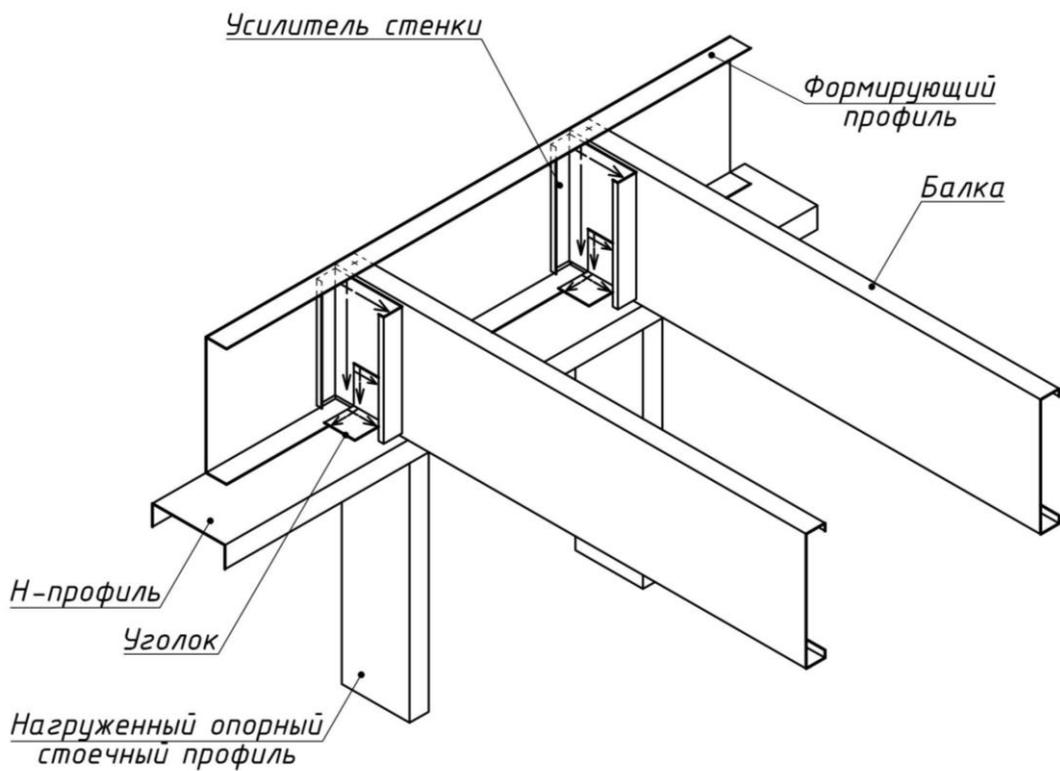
Узел П 12. Крепление усилителя стенки
